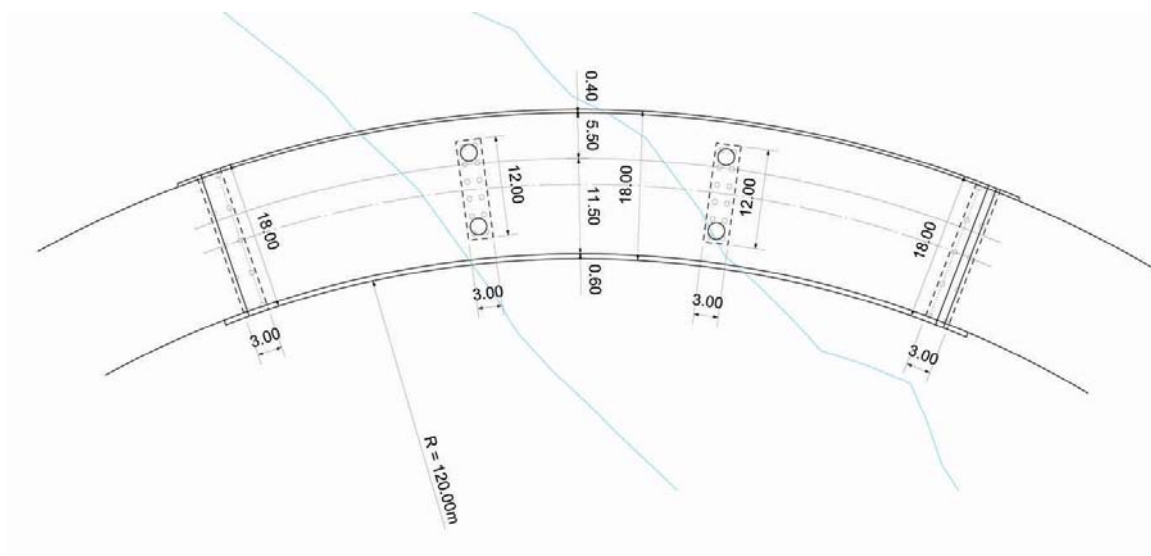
Planta da Ponte Proposta sobre o Canal São Joaquim
